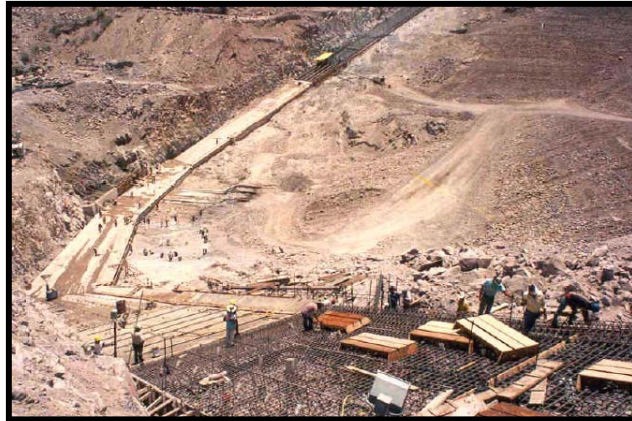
Proceso de construcción de la losa perimetral del plinto. Nótese la colocación del acero de refuerzo en ambas márgenes
